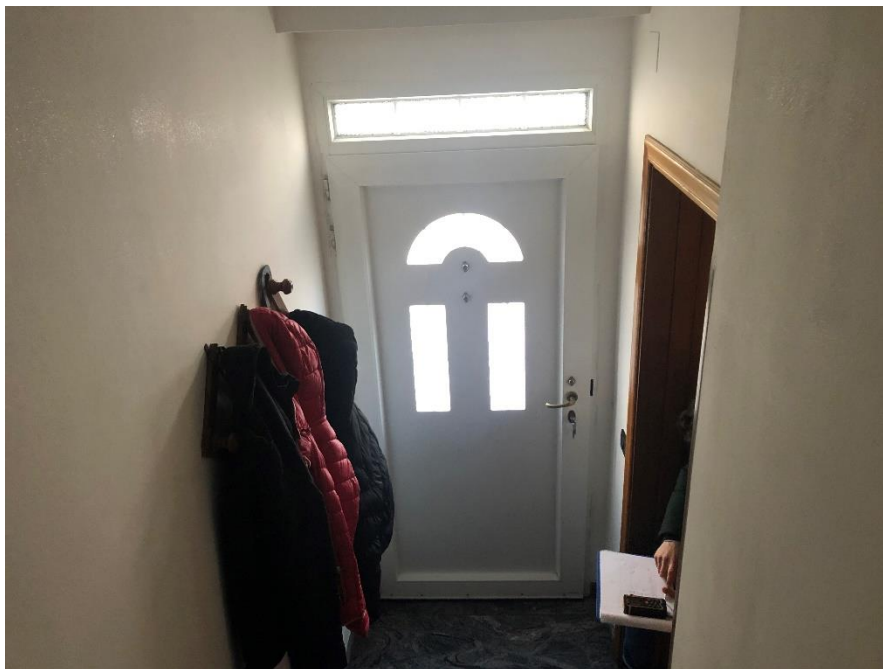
Porta Ingresso Vano scala P.T verso 1°P
